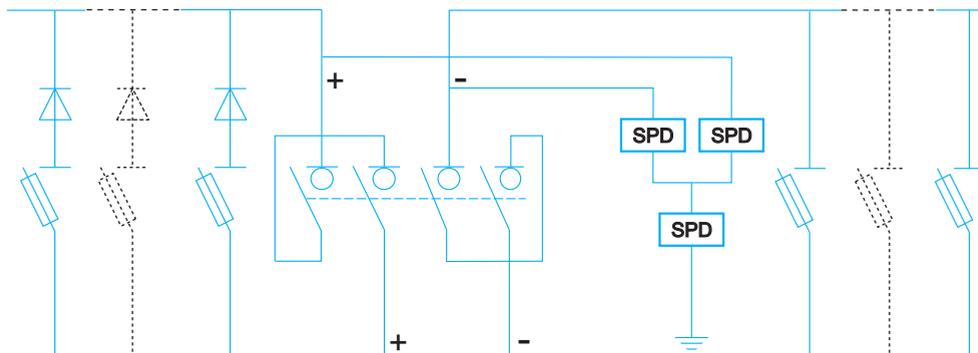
installazione dell'SPD a monte dell'interruttore di manovra e sezionamento
